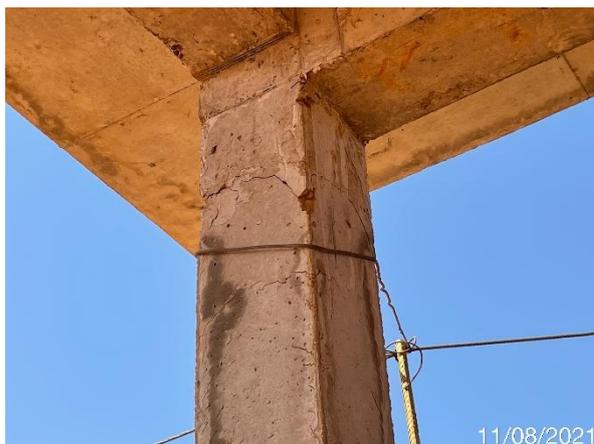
Presença fissuras e trincas (Data da imagem: 11/08/2021)
